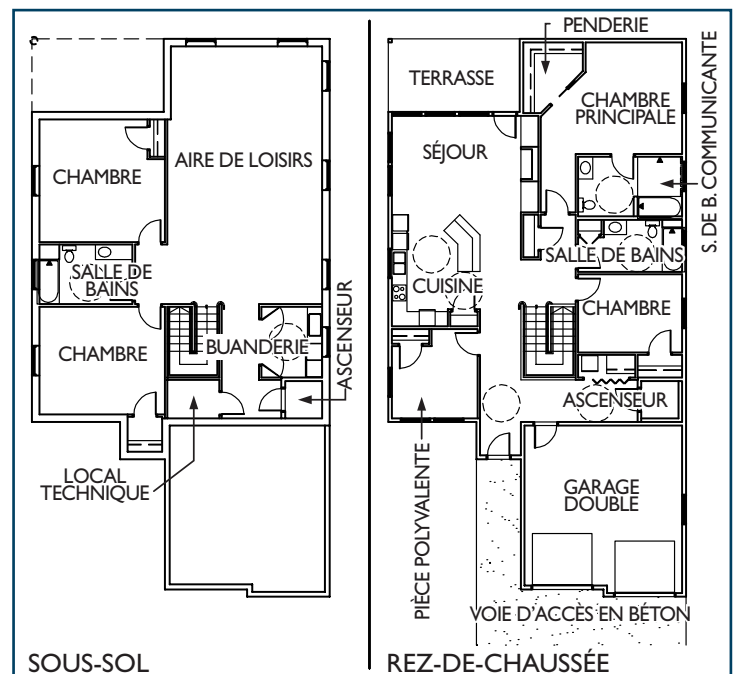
Plans du sous-sol et du rez-de-chaussée d'une habitation accessible
